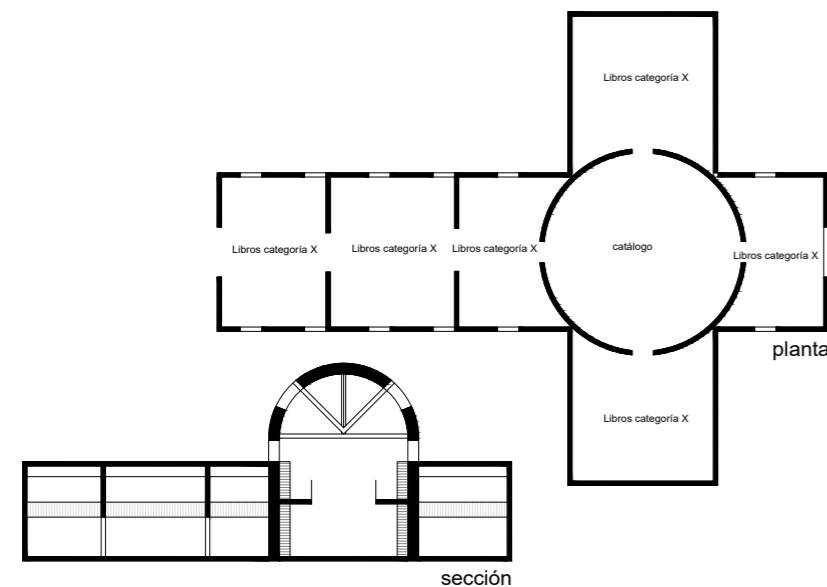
Biblioteca Planta en Cruz. Compartmentación
